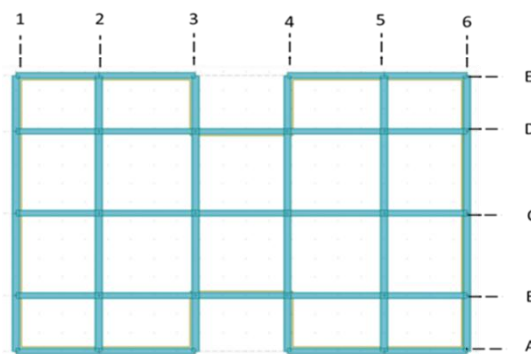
Vista en planta de los modelos M16RC, M17RC y M17M
